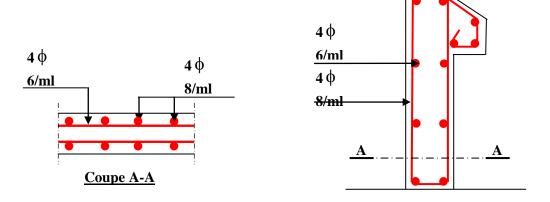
Schéma de ferraillage de l'acrotère (Terrasse inaccessible).
